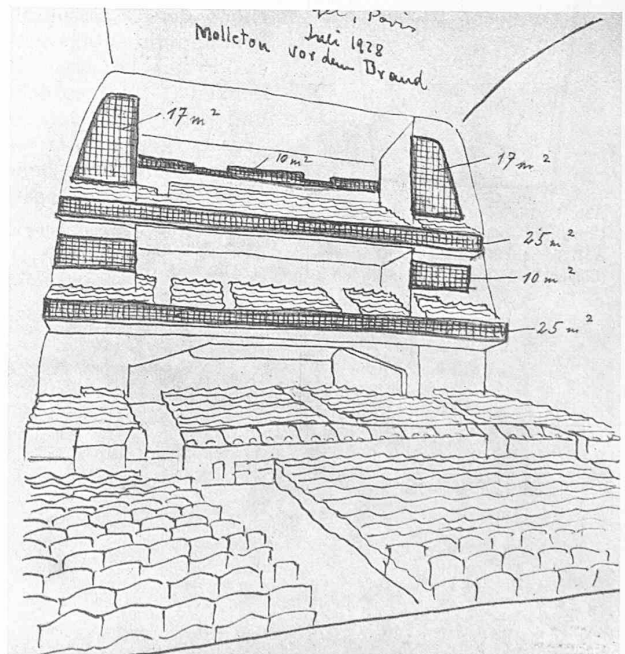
Erste Molleton-Dämpfung, vor dem Brande, wie oben.
